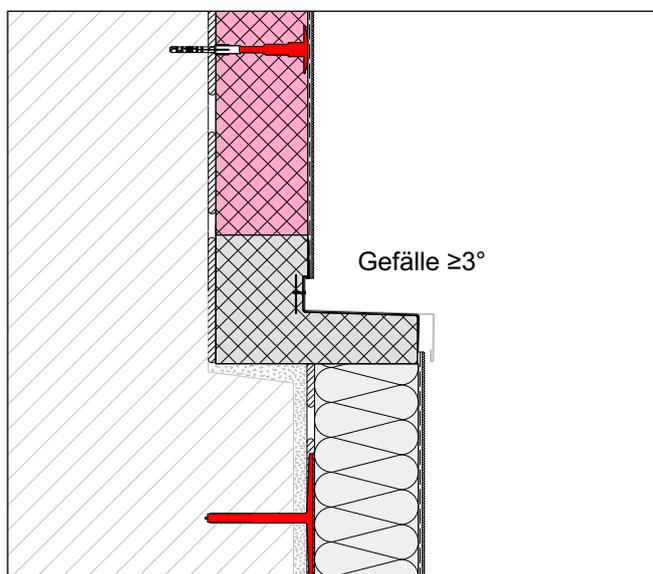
Ausführung mit Baumit SohlbankanschlussProfil
